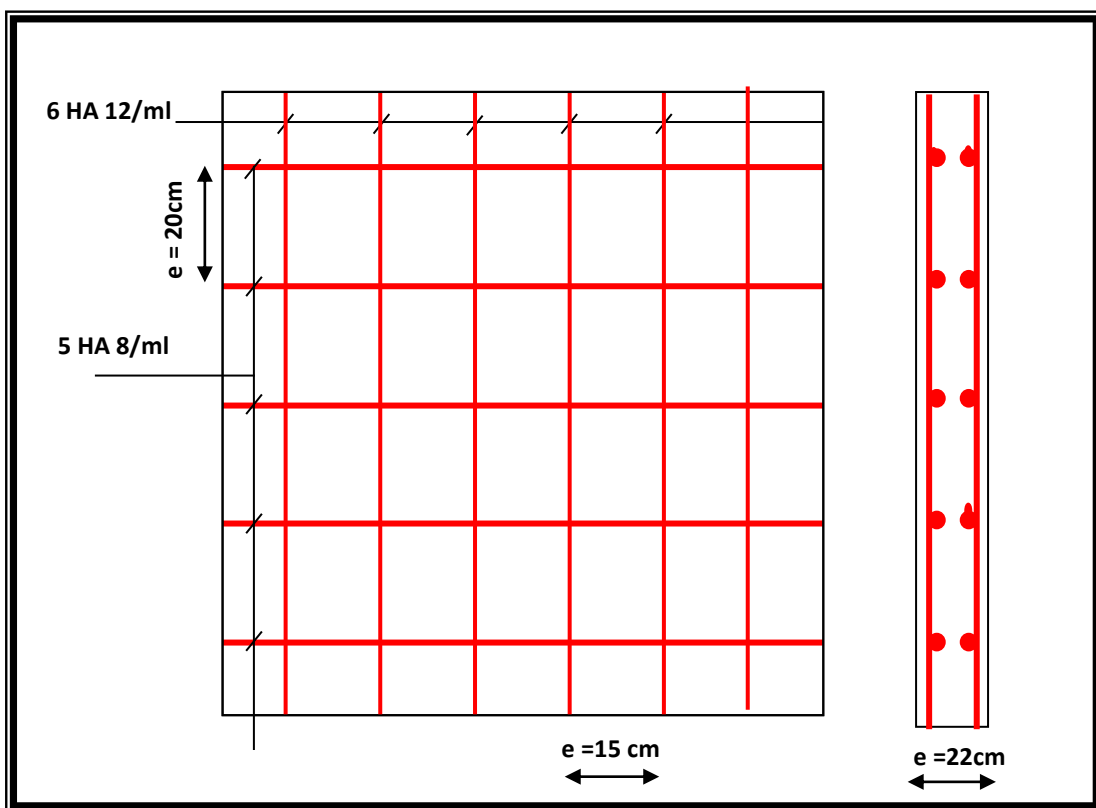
Ferrailage du voile périphérique et mur de soutènement dans les deux sens pour 1m<sup>2</sup>
